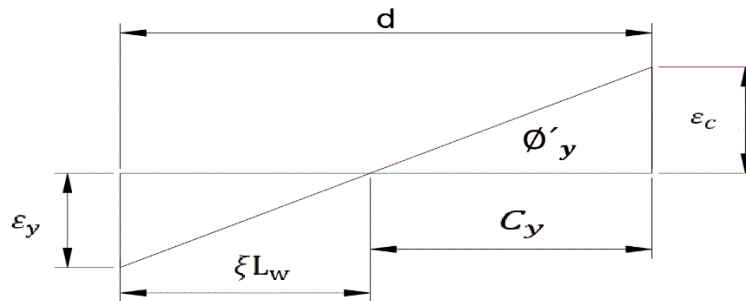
Perfil de deformaciones de un muro de hormigón armado
